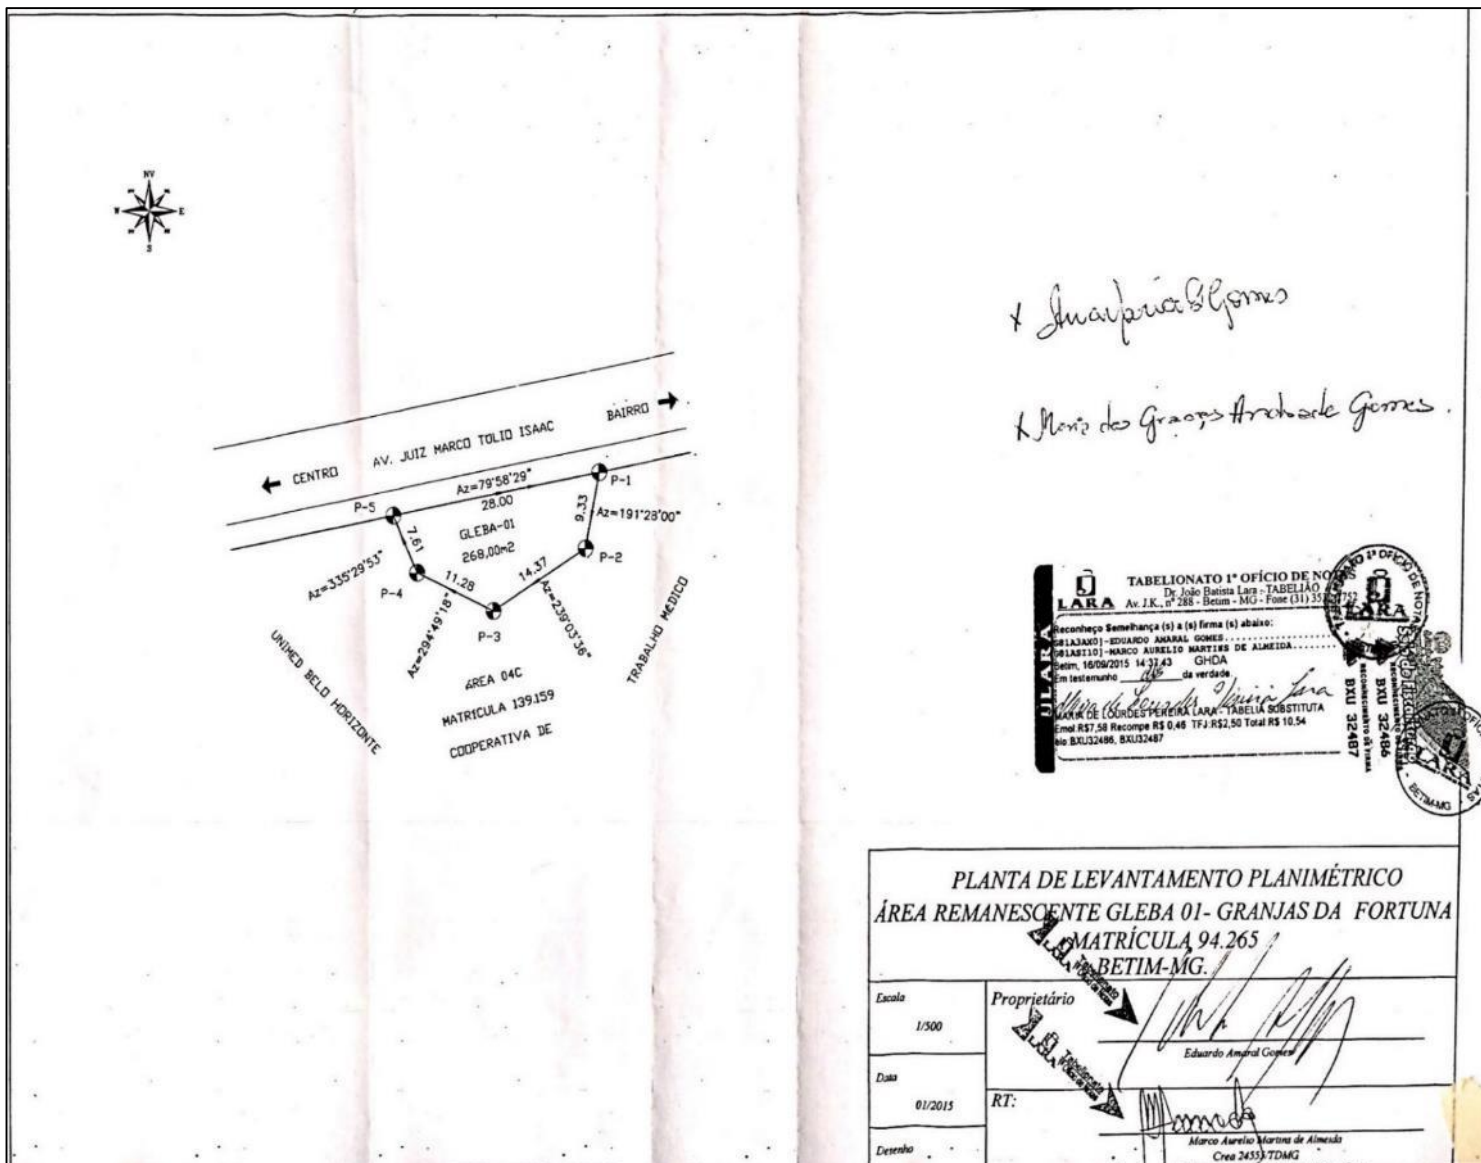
Planta de levantamento planimétrico de janeiro/2015. (Fonte: S.R.I. da Comarca de Betim/MG).
